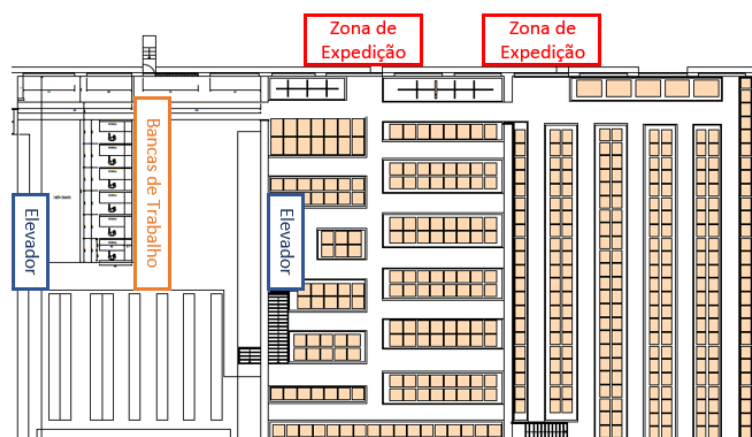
Planta *Layout* Piso de Expedição da IRON
